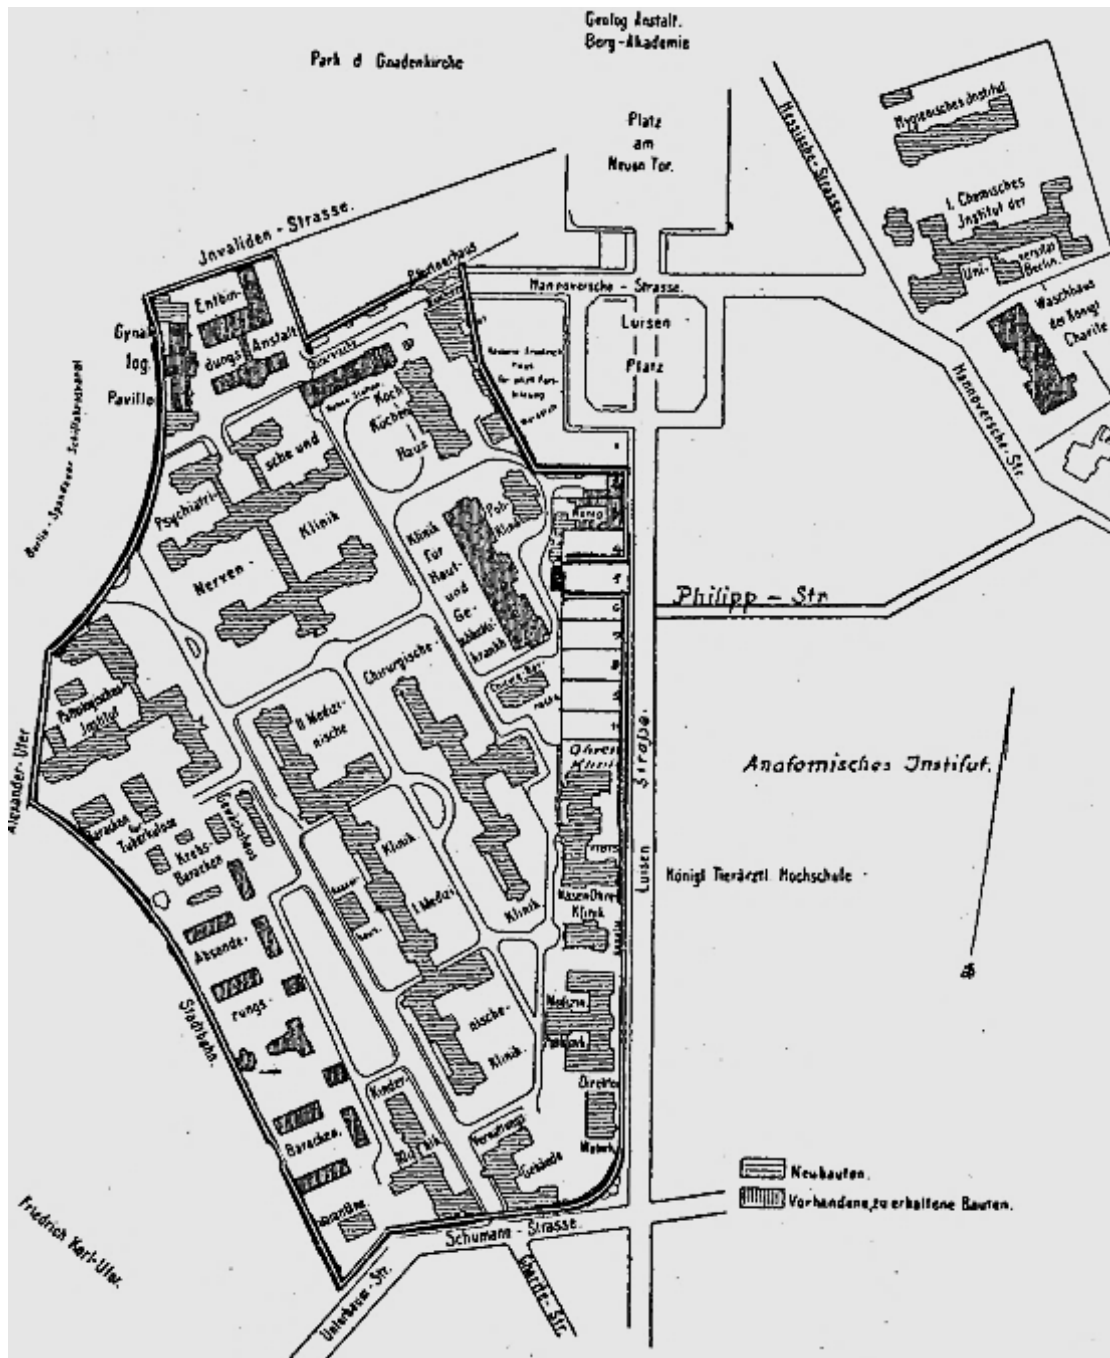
Lageplan der Berliner Krebsbaracken (1910)
